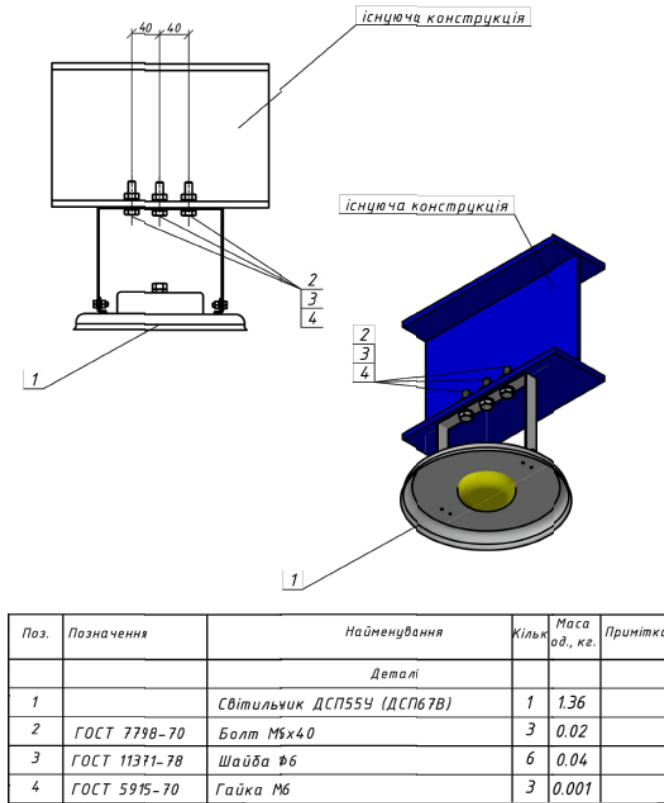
Установка світильника ДСУ55У на металевій конструкції
